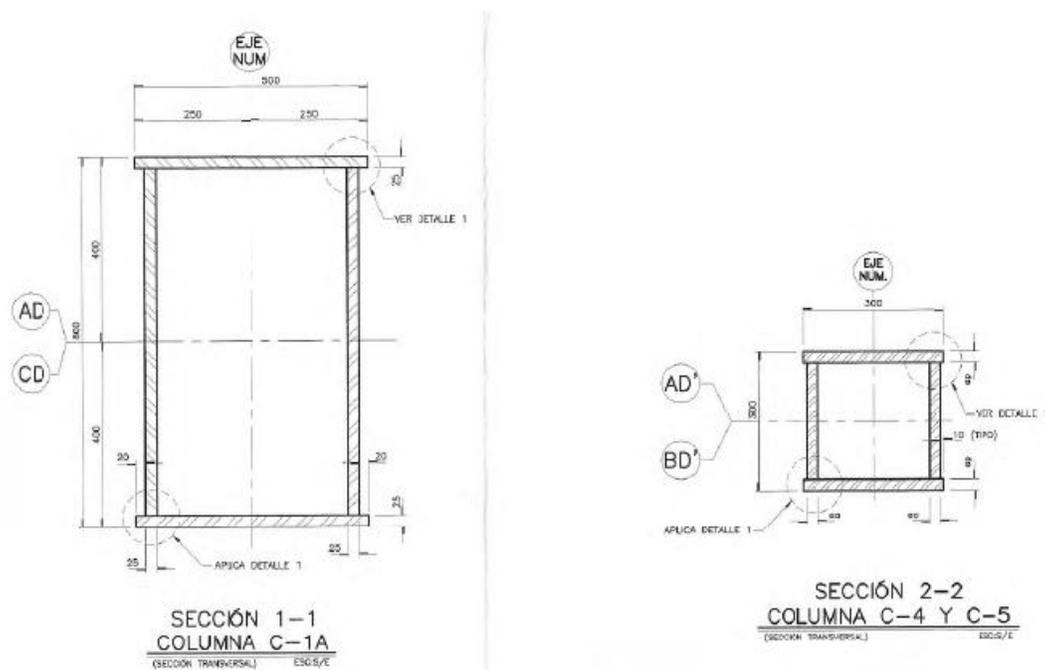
Sección de columnas tipo cajón principales C-1A, secundarias c-4 y c-5.
